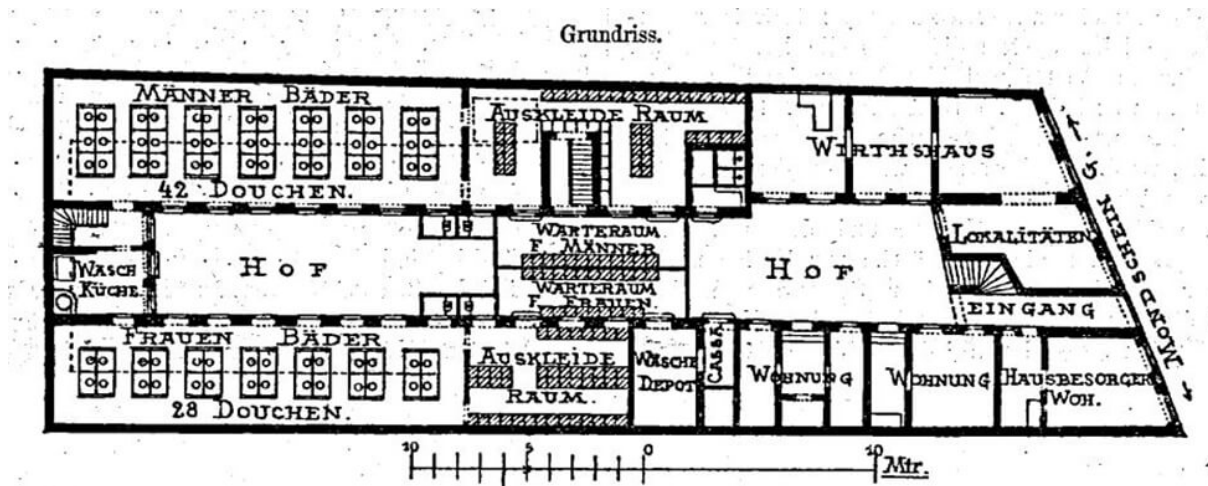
Grundriss mit Brausen 2. Klasse des ersten Volksbades in der Mondscheingasse
